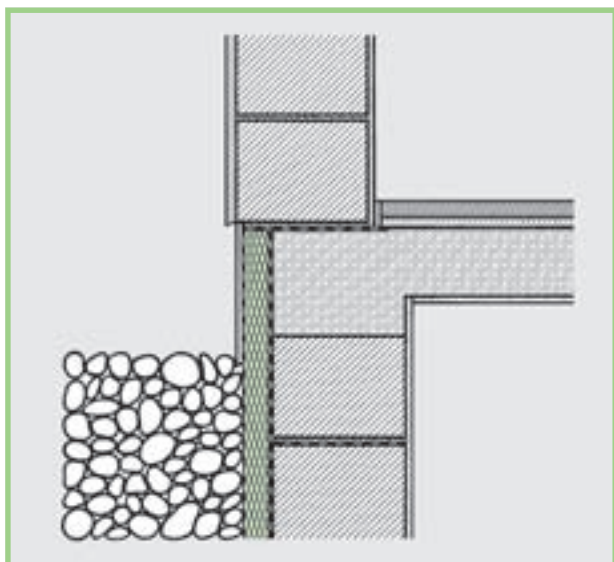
Zócalos, aislamientos perimetrales con mampostería vertical con aislamiento térmico.
